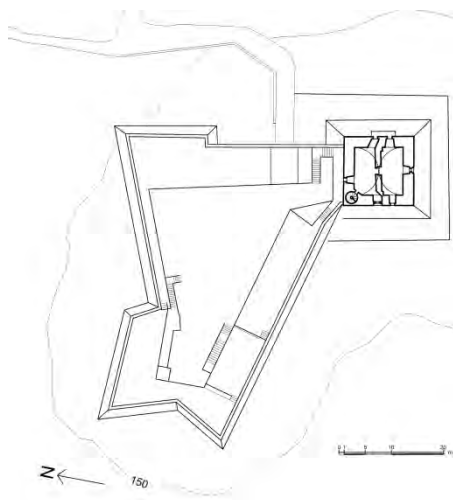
Planimetria del forte Sant'Angelo a Licata (da Carità, 1977, ridisegnato).
